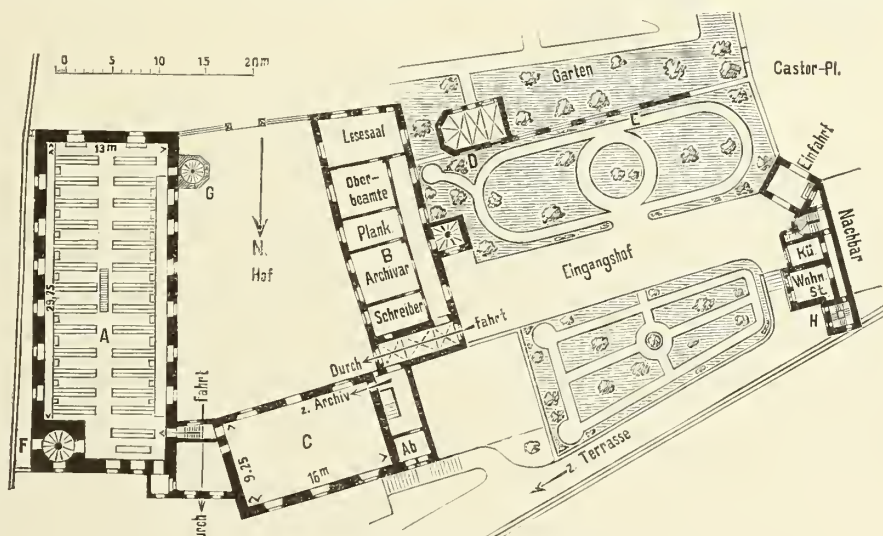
Erdgeschoss-Grundrisse des Deutschordenshauses (Archiv) und des Pfortnerhauses.
